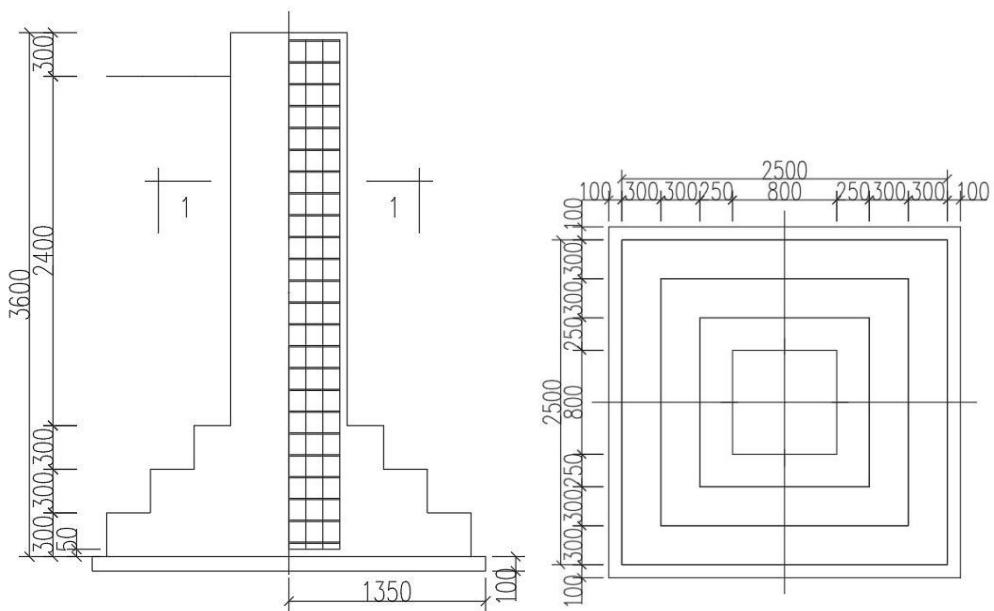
耐张塔基础型式图 (尺寸单位: mm)
